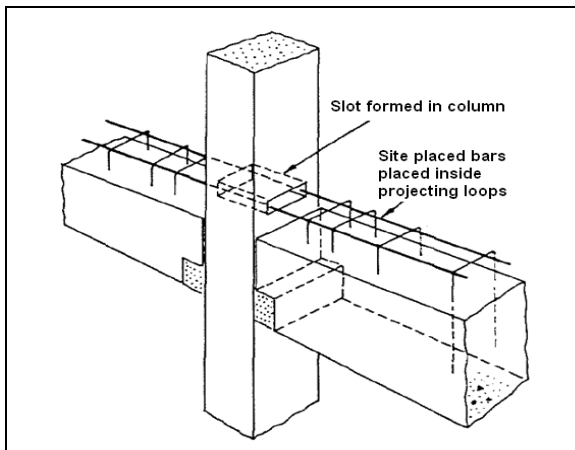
Ligação por consola curta de betão e armadura ordinária (Elliott, 1996)
